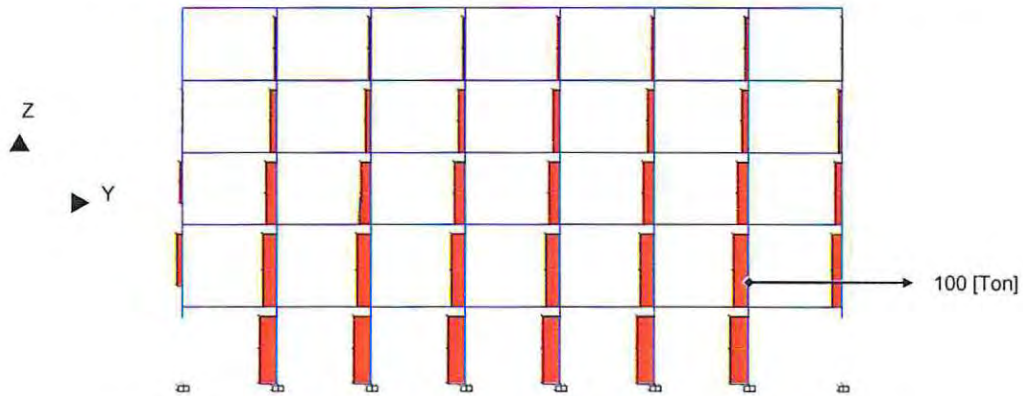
Diagrama carga axial en columnas interiores, eje B, estructura aislada.
